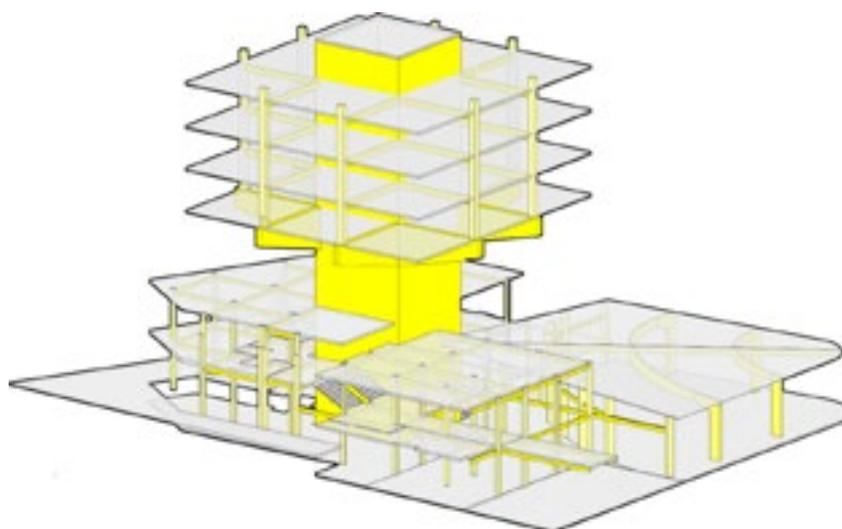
Plano mostrando los elementos estructurales. Elaboración propia
